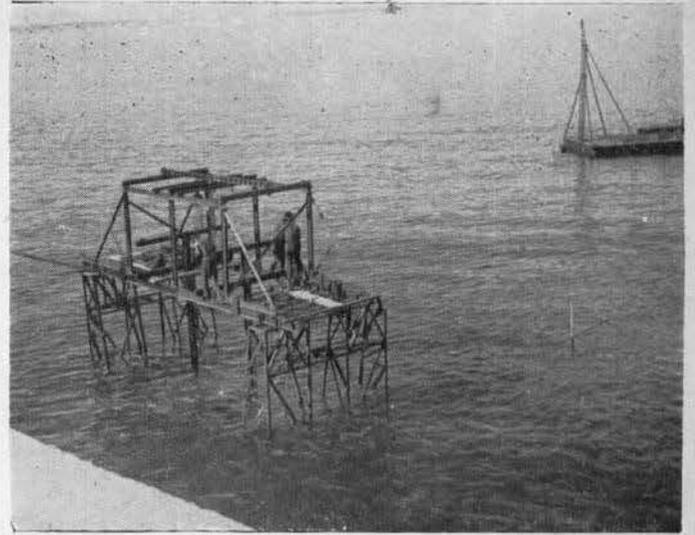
Obra falsa para la construcción de las pilas.—Nótese la araña señalando la posición aproximada de la próxima pila
